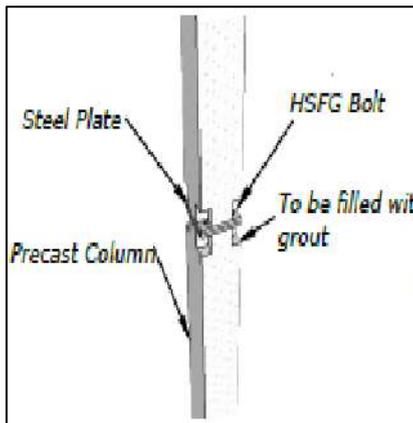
assemblage deux poteaux. Source : PRE ENGINEERED BUILDING-pdf
